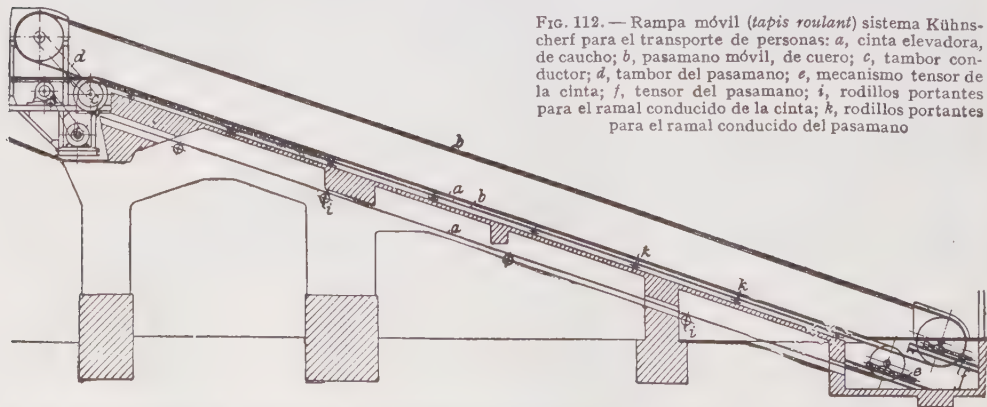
Rampa móvil (*tapis roulant*) sistema Kühnsherf para el transporte de personas: a, cinta elevadora, de caucho; b, pasamano móvil, de cuero; c, tambor conductor; d, tambor del pasamano; e, mecanismo tensor de la cinta; f, tensor del pasamano; g, rodillos portantes para el ramal conducido de la cinta; h, rodillos portantes para el ramal conducido del pasamano
